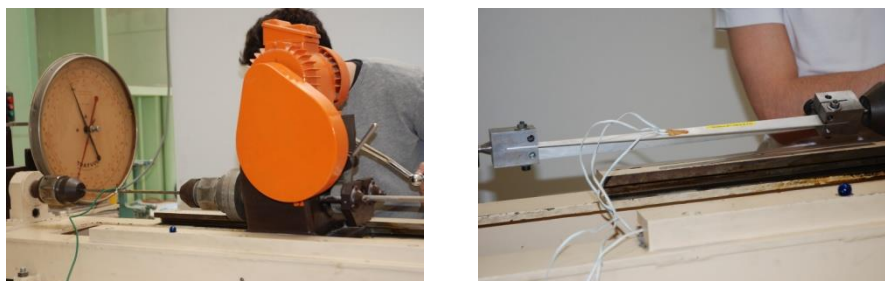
Essais sur barres cylindriques équipées, essais sur cornière en L
